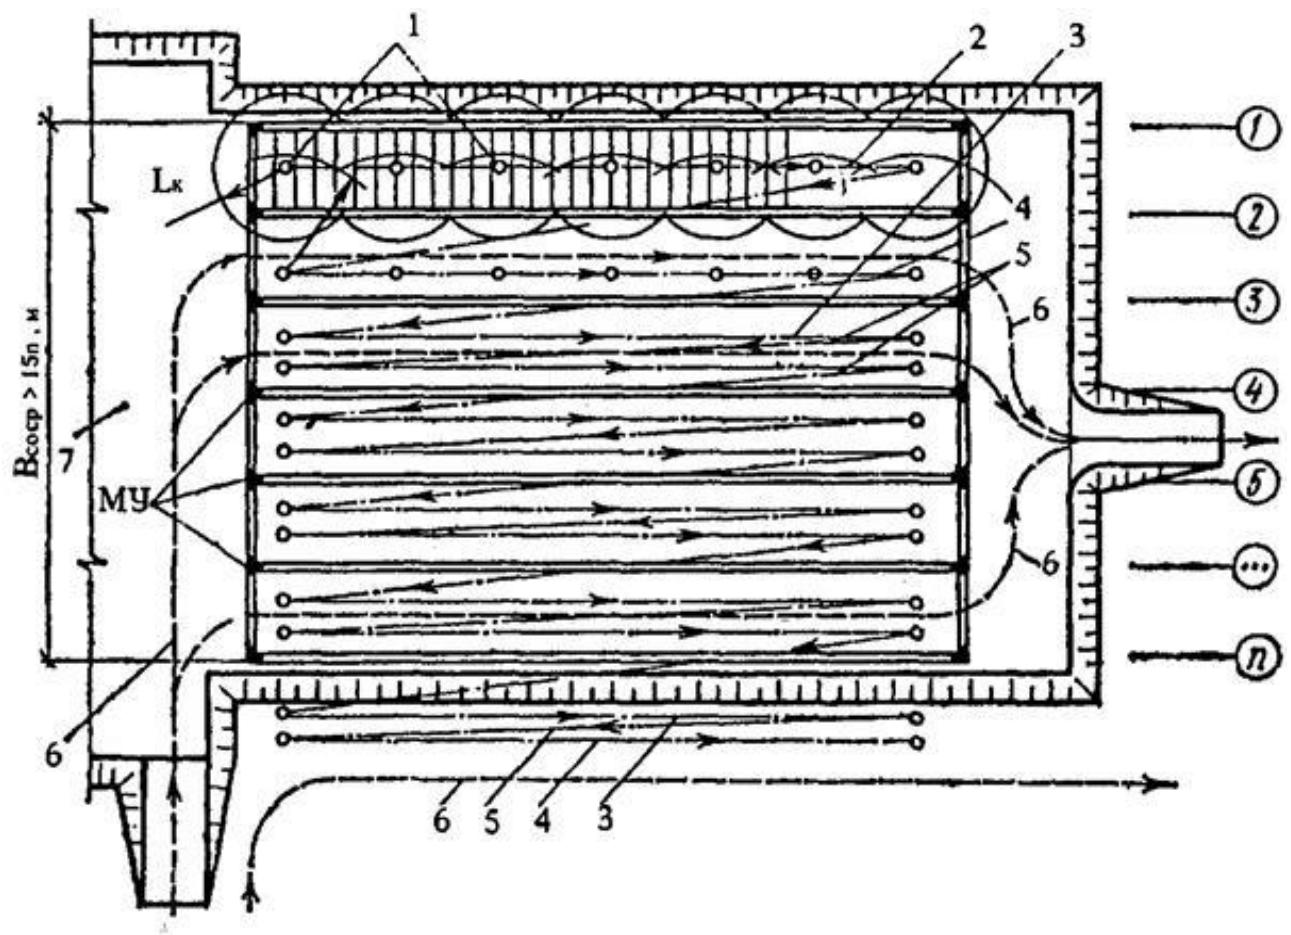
Принципиальная схема монтажа горизонтального отстойника:
